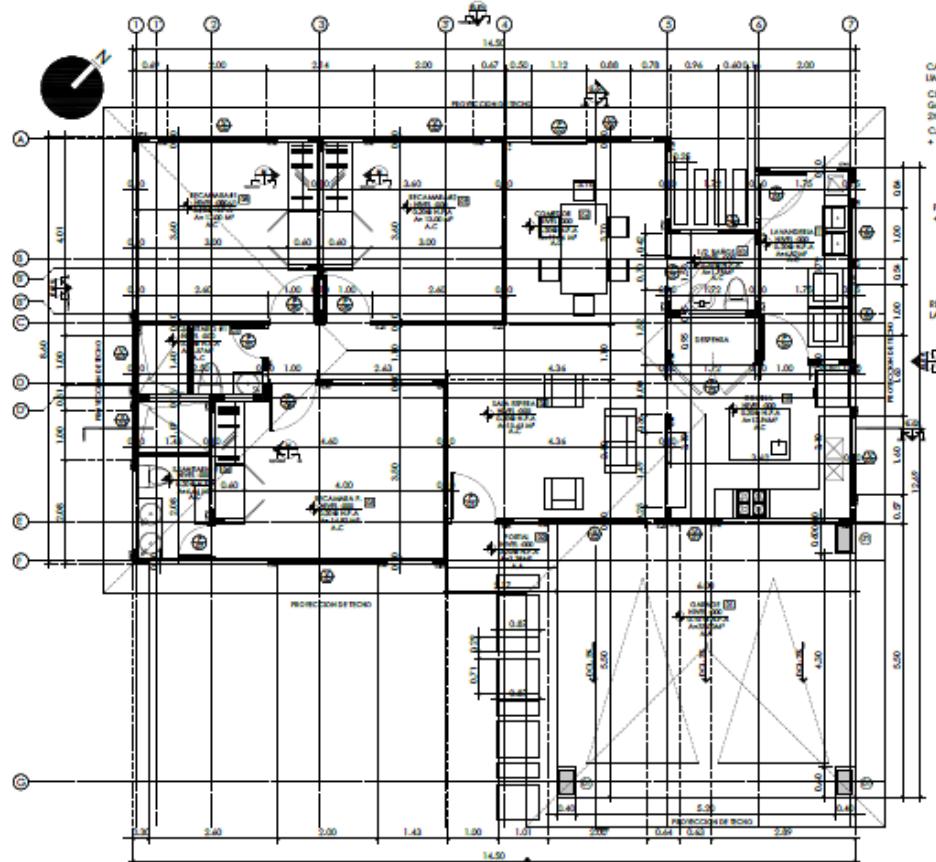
Plano de casas de 3 recamaras del proyecto.
